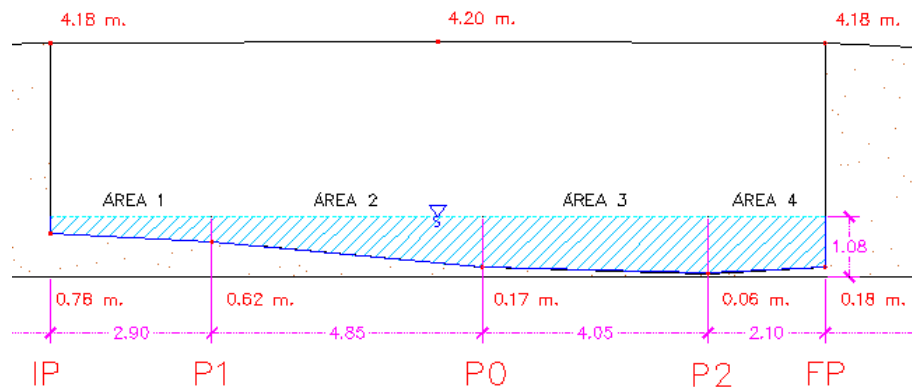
Sección transversal del canal El Macho PM. Ubicación: 10 de Agosto
